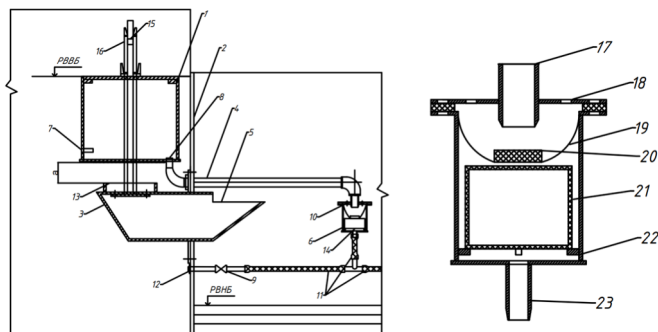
Схема гідроавтоматичного регулятора : 1 – затвор (запірний циліндр); 2 – перегороджуюча стінка; 3 – зливний лоток; 4 – патрубок для випуску води зі стравлювача; 5 – зливний отвір лотка; 6 – корпус датчика-прискорювача; 7 – вхідний патрубок затвора; 8 – вихідний патрубок затвора; 9 – вентиль для налаштування регулятора; 10 – випускні отвори датчика-прискорювача; 11 – гідрозв'язок; 12 – патрубок для наповнення гідрозв'язка; 13 – кільцевий водозлив водопропускного лотка; 14 – поплавков датчика-прискорювача; 15 – стопорна шайба; 16 – рама гідроавтоматичного регулятора; 17 – патрубок для підключення гідрозв'язка до датчика рівня; 18 – отвори для випуску води; 19 – мембрана; 20 – ущільнення; 21 – поплавок датчика рівня; 22 – корпус датчика рівня; 23 – патрубок для випуску і води в скидний колодязь
